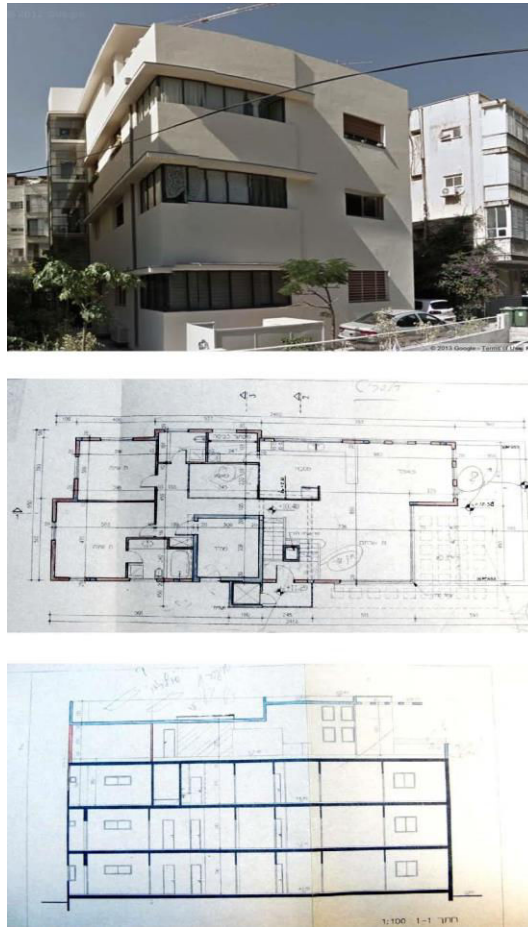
24, Rue Shalom Aleikhem, En haut: extrait de la façade, extrait: site Google Street, 6.7.2013 Au centre: Plan de l'étage sur le toit, extrait du permis de construire, source: ADCTJ. En bas: Coup en longueur a travers la construction composée, extrait du permis de construire, source: ADCTI,
